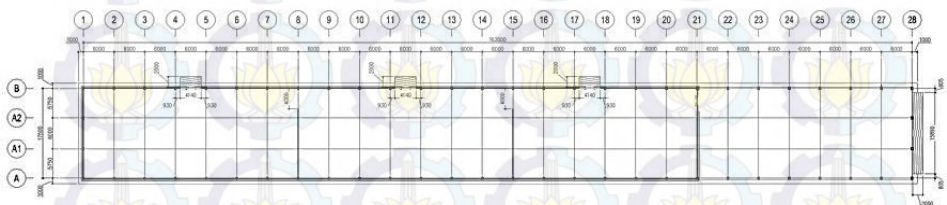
Denah Struktur Sistem Pre-Engineering Building
